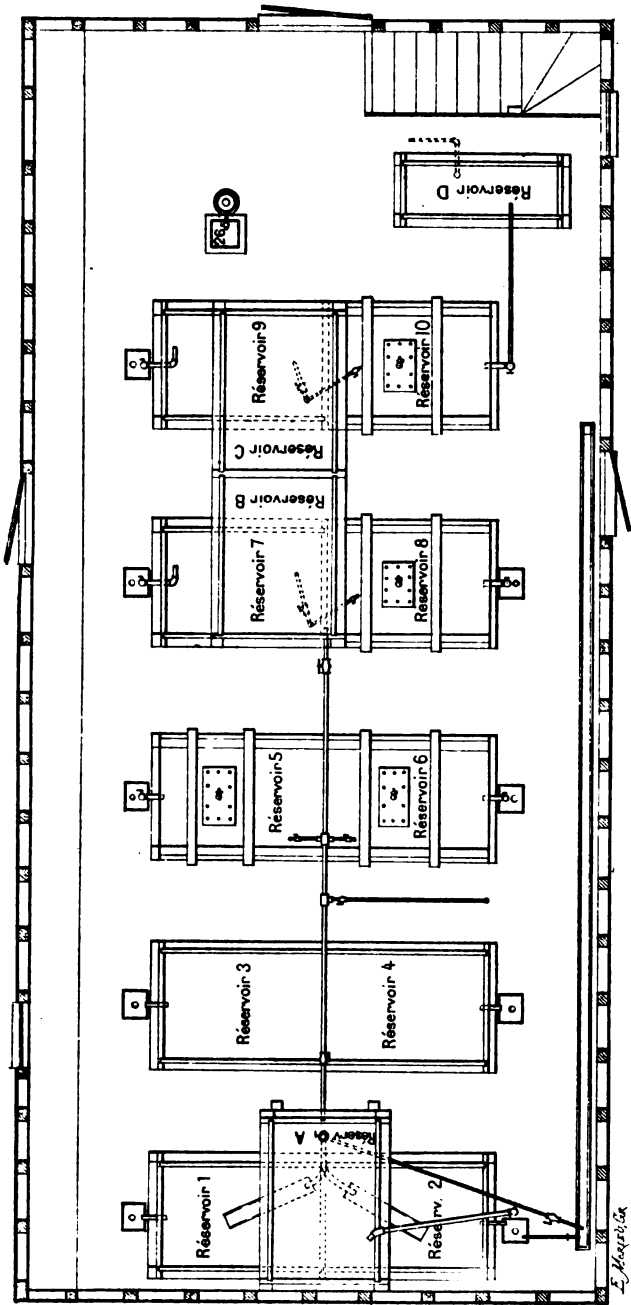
Plan de l'étage de la station expérimentale de Boston (Massachusetts).
